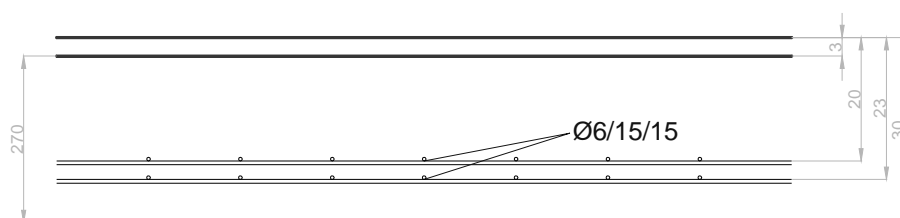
Sezione verticale della platea di base (ricostruzione da saggio n.1).
